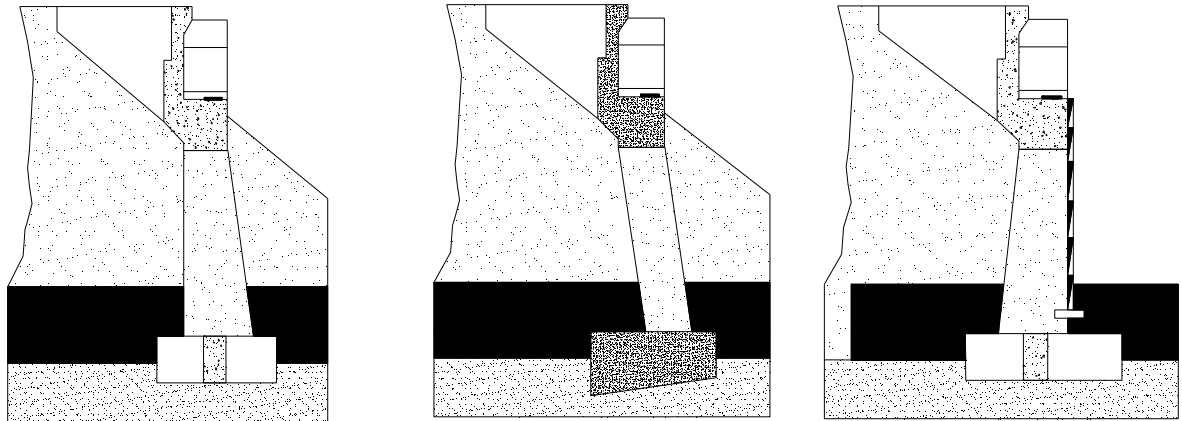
Estribo abierto con tres pilas o fustes
